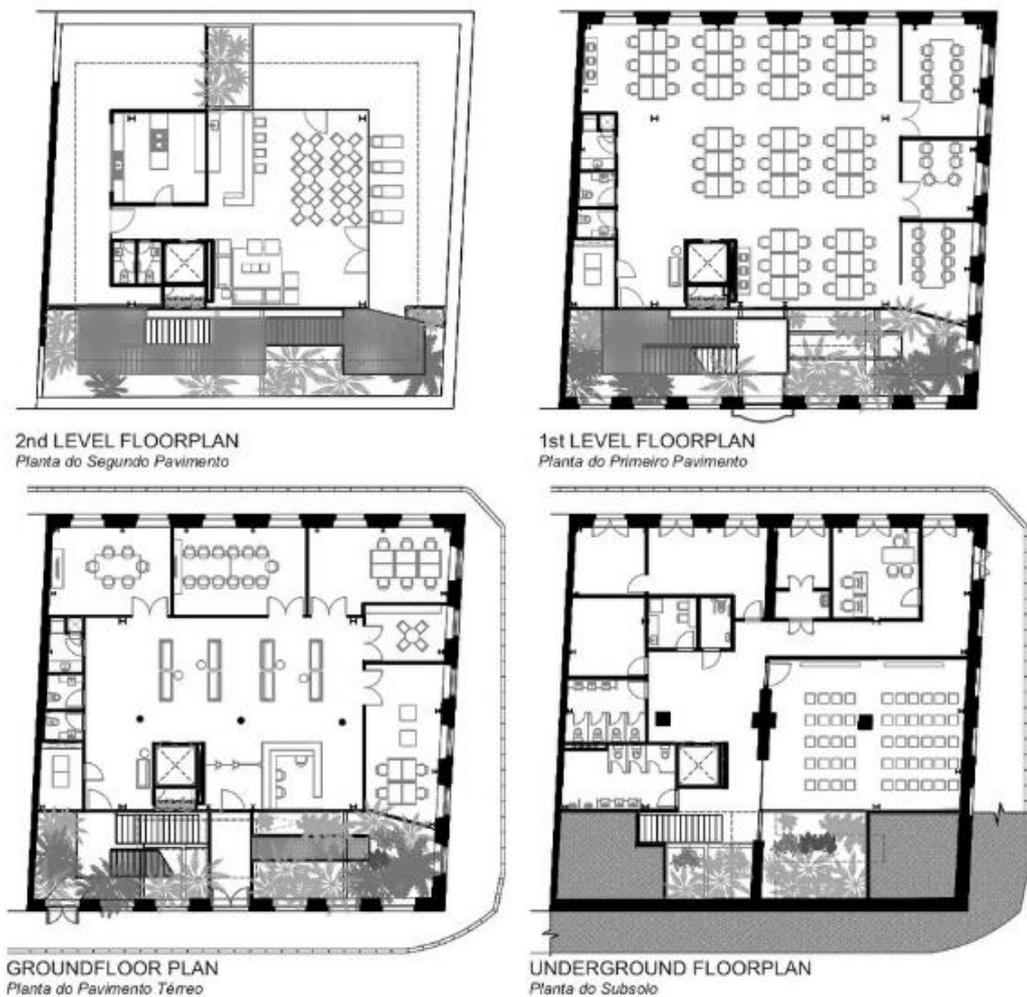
Planta baixa dos pavimentos após intervenção, adaptado de Abdel (2021).
